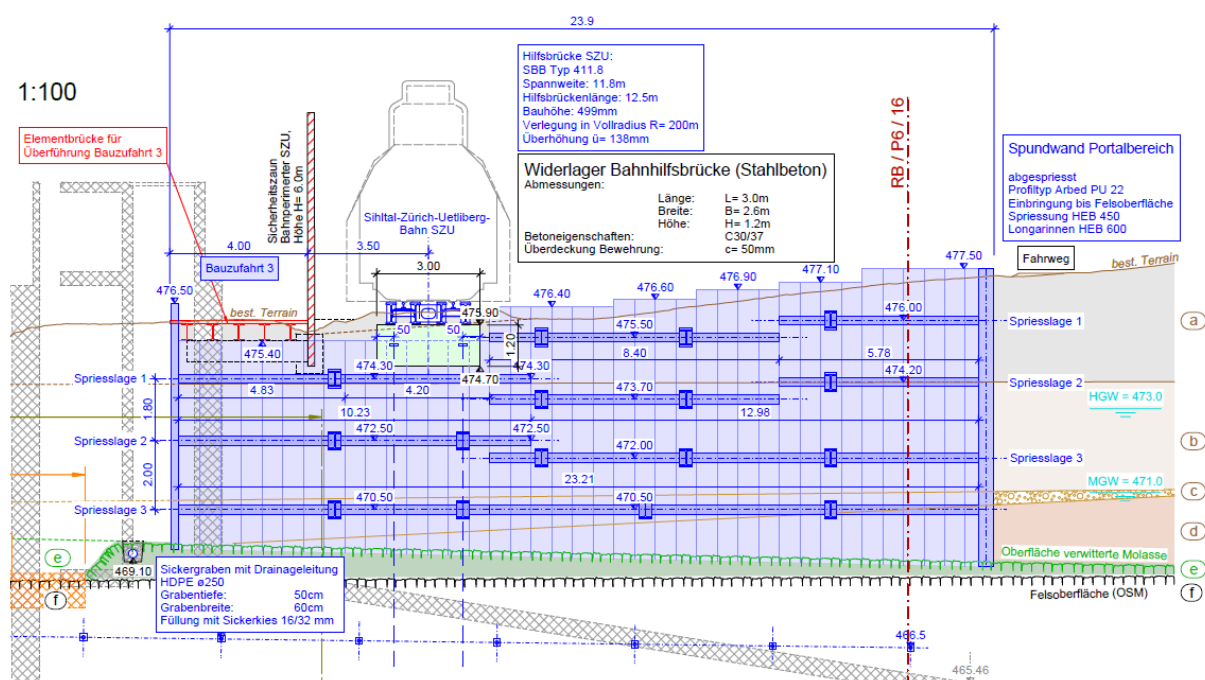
Schnitzauszug Spundwandkasten Portalbereich mit Spriesslayout
